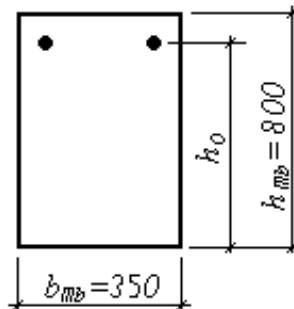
Розрахунковий переріз головної балки на опорах
